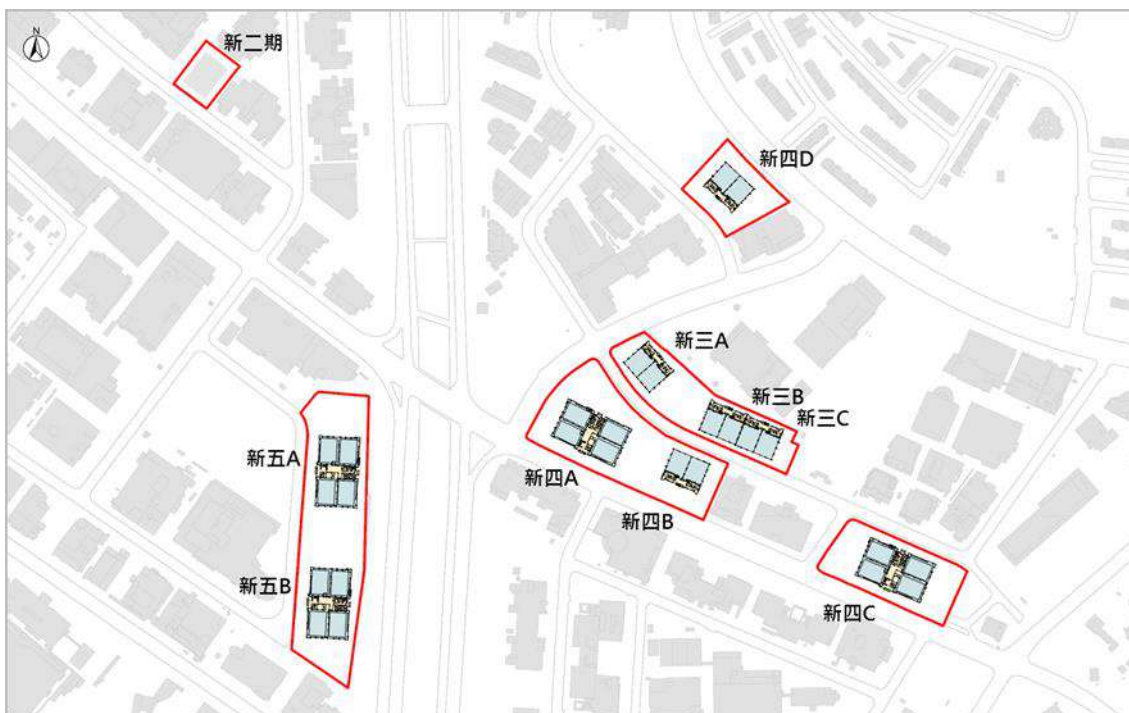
方案三新標準廠房配置位置構想示意圖
